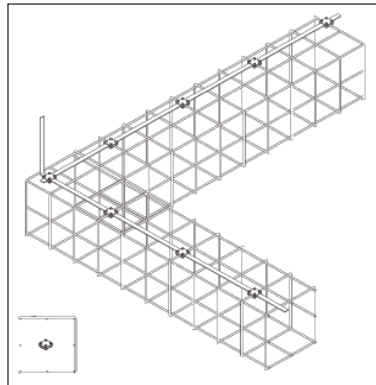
Das Verdichten des Betons ermöglicht es, den Bandstahl auch flach auf einem Bewehrungskorb zu verlegen
